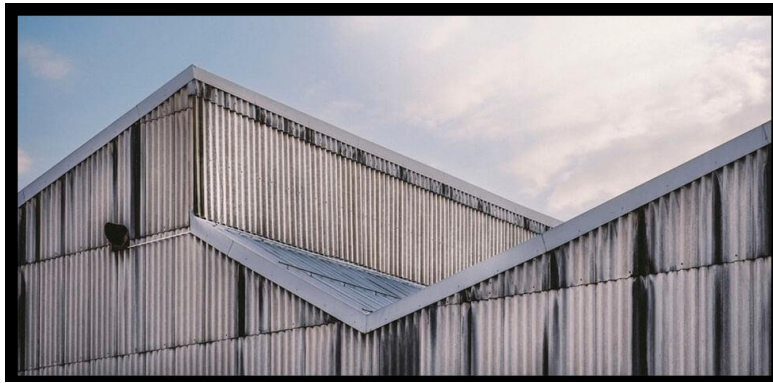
Cubierta con canal intermedio (Cubiertas del centro, s.f.)
